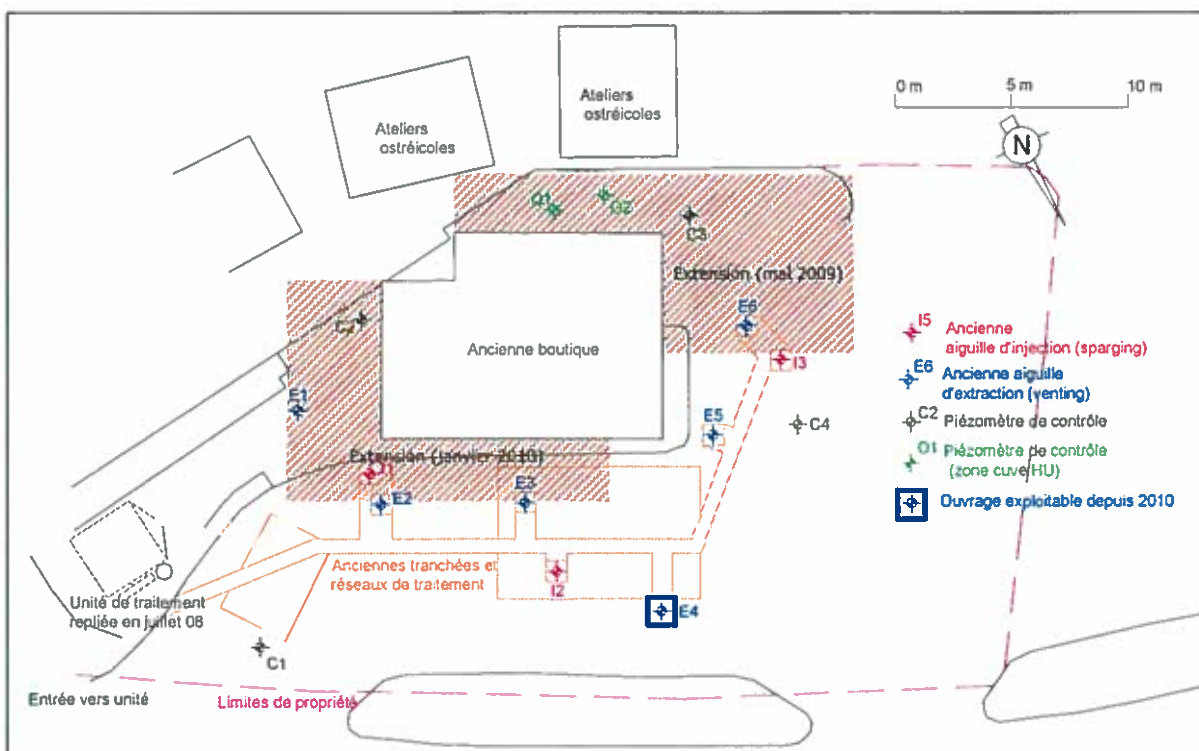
Plan du site et d'implantation des ouvrages (unité de traitement repliée en juillet 2008)
